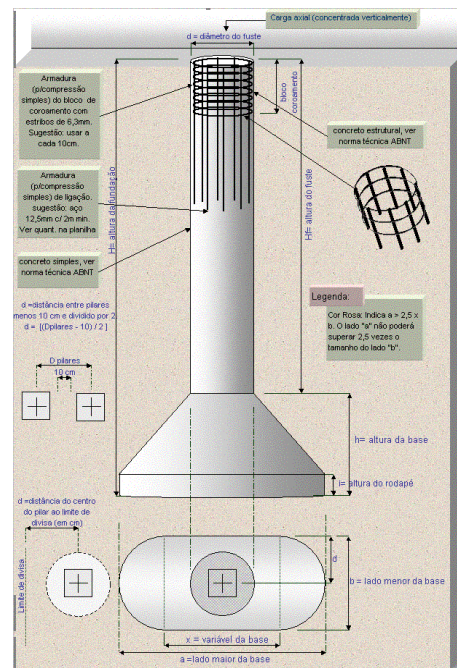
Blocos sobre tubulões e pilares diretamente sobre o tubulão (FONTE: AltoQi, s/d).
